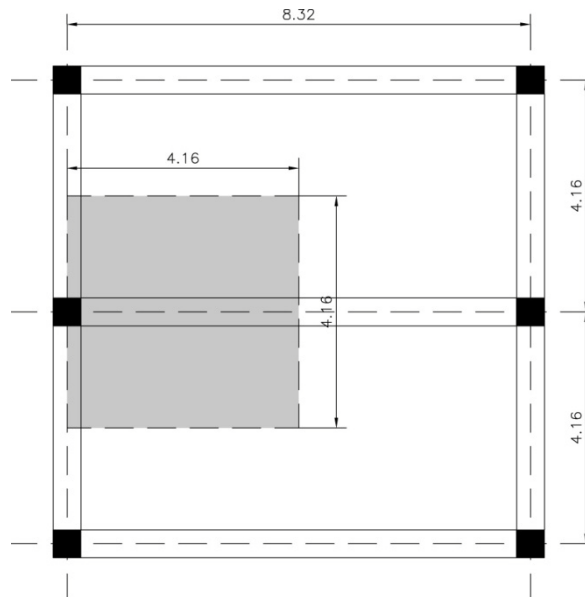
Disposizione degli elementi strutturali del corpo avente luce massima pari a 8,32m con evidenziata l'area di influenza del pilastro calcolato
